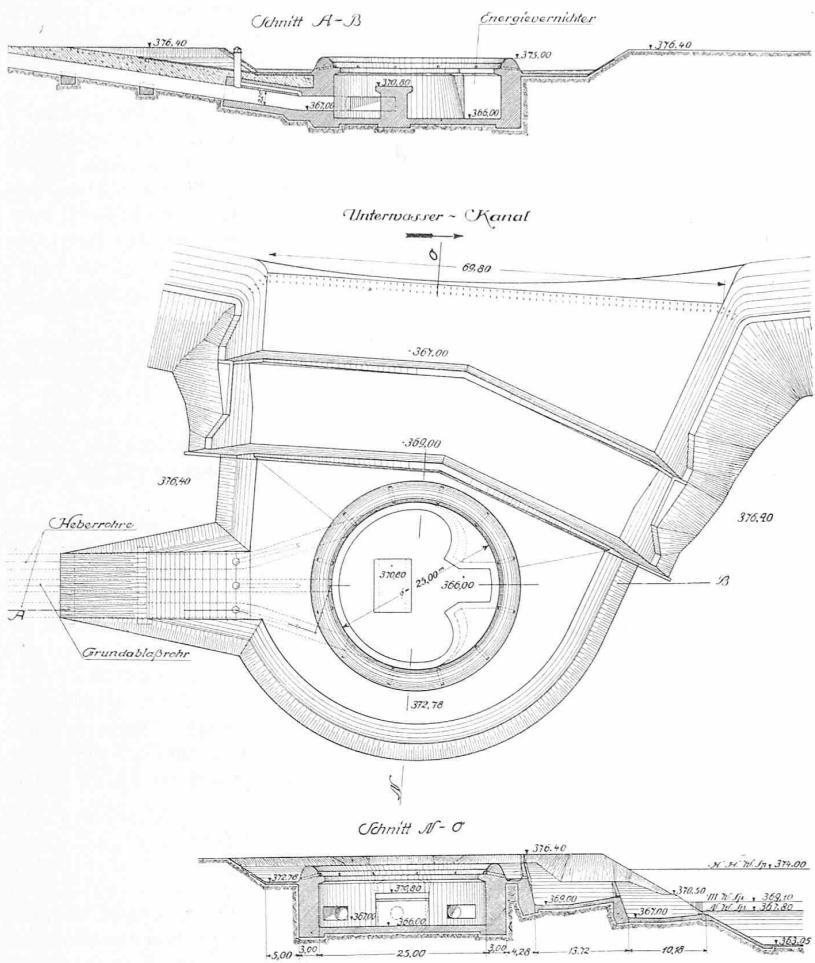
Grundrisse und Schnitte des Energievernichtungsbeckens. — Maßstab 1:1000.
